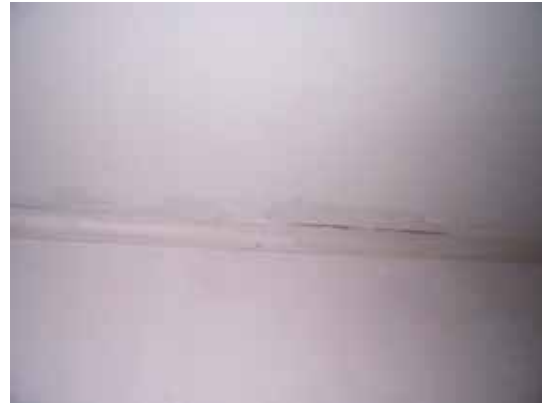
Grieta oblicua en el dormitorio.
